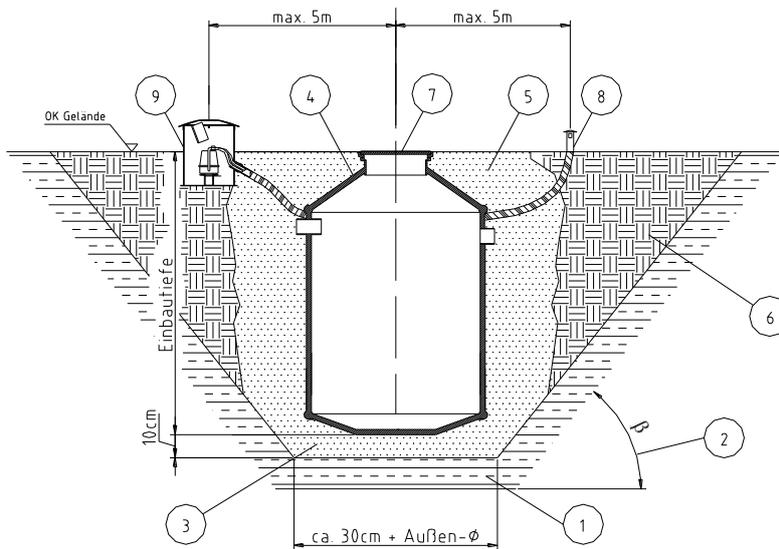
Einbauskizze TORNADO Kleinkläranlage
